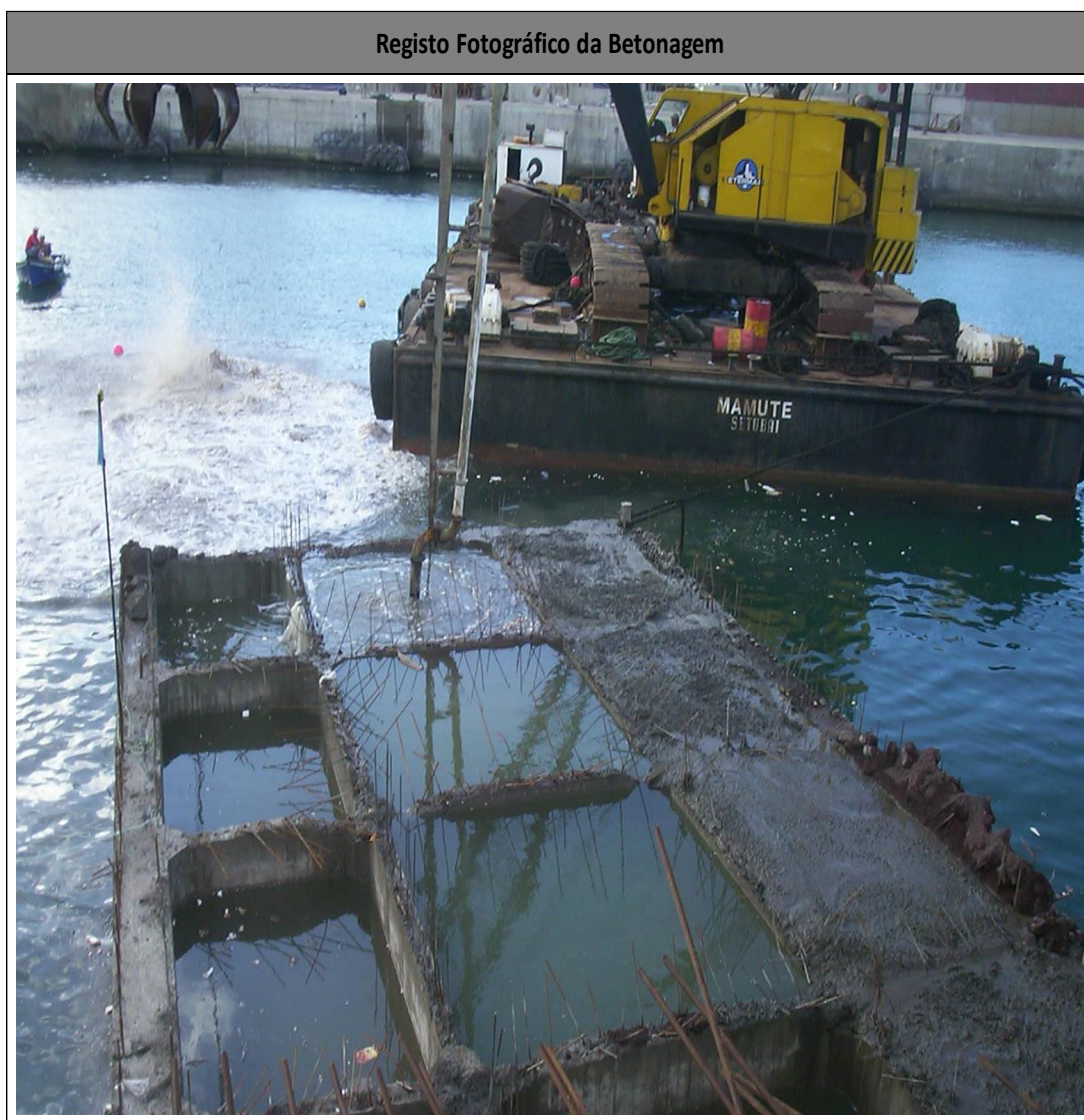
Excerto da ficha técnica - Betonagens “*in situ*” (Porto do Caniçal - Rampa *Ro-Ro*).
